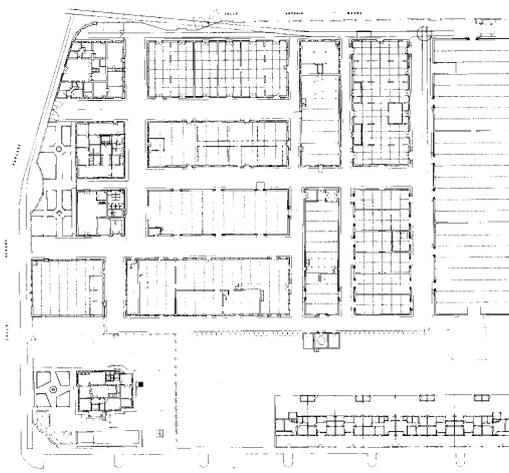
Planta general del conjunto de edificios tras la ampliación. (Fuente: SV60 Cordón & Liñán Arquitectos)
